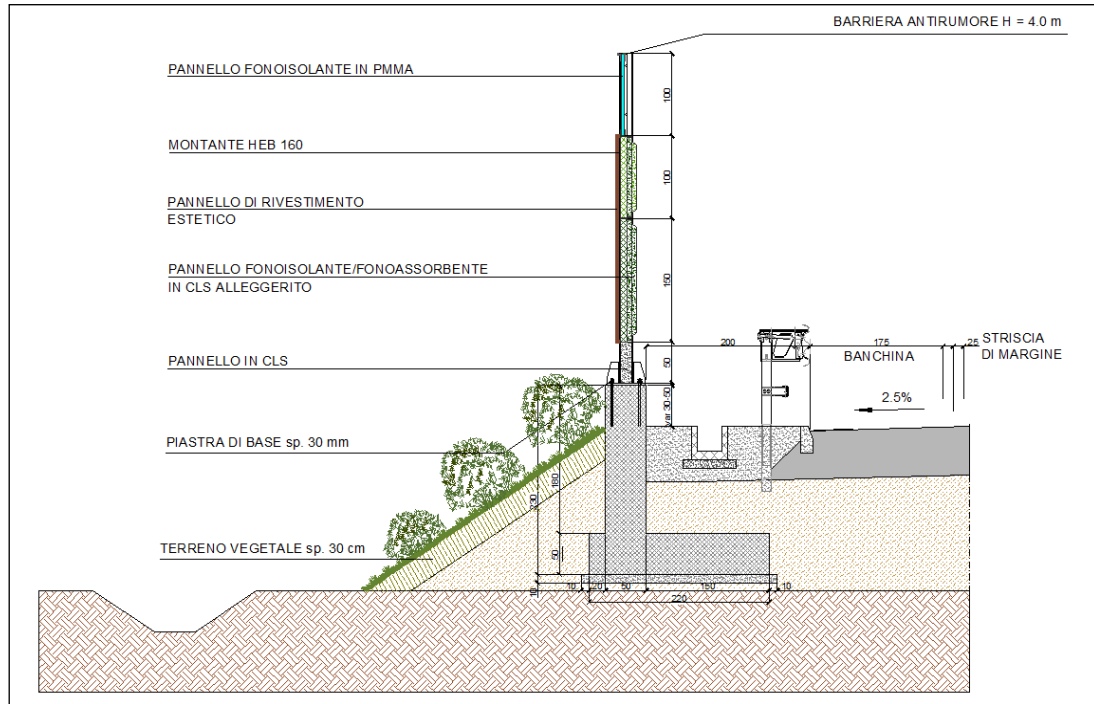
SEZIONE TIPO BARRIERA H 4,0 M
